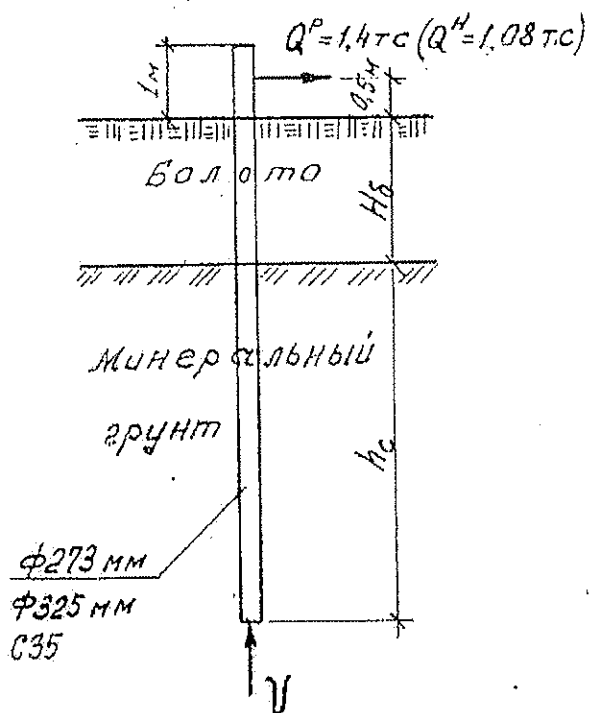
Расчетная схема сваи для опор анкерного типа в нормальном режиме (четыре сваи на одну опору)
